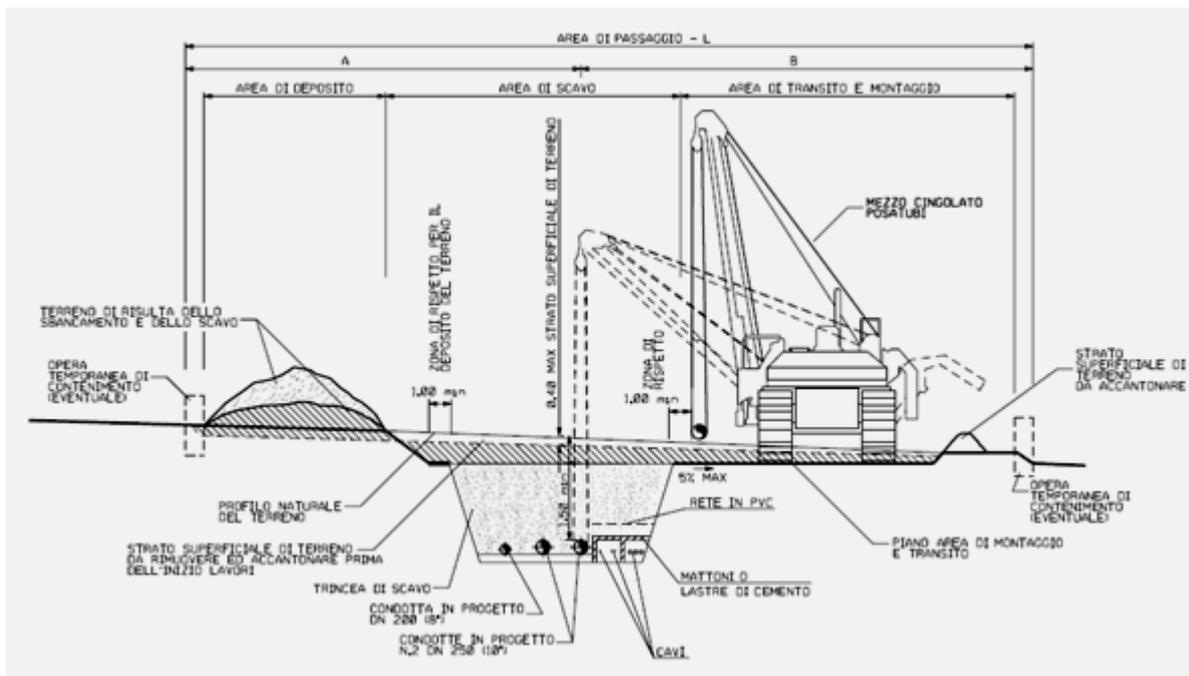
tipico pista di lavoro (Fonte: Standard di progetto – Relazione tecnico Illustrativa di Progetto – Allegato 3.6)
